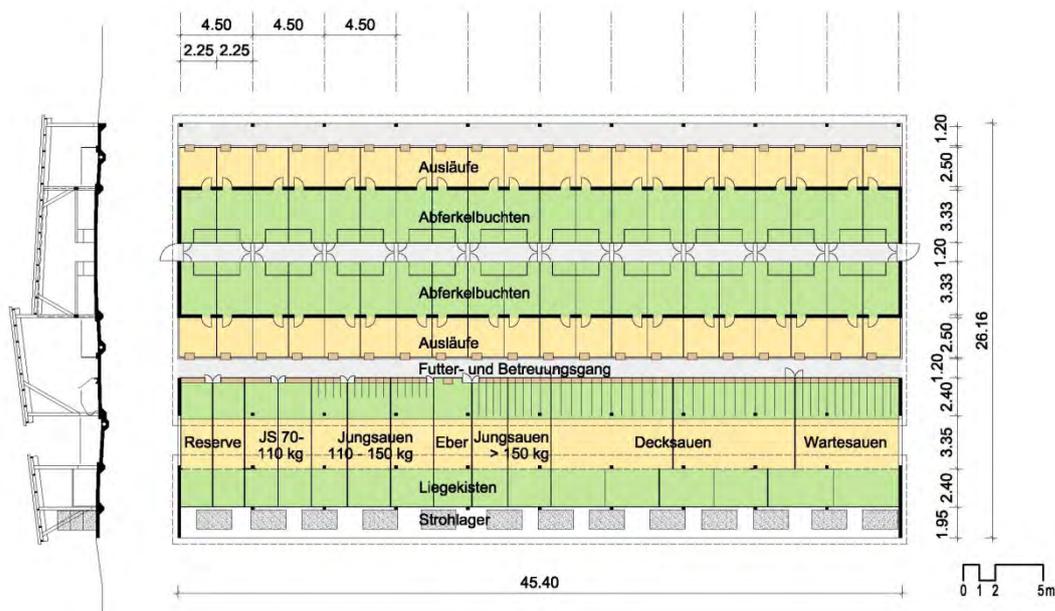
Grundriss und Schnitt des Kompaktstallabteils MODELL II mit außenliegender Fütterung
